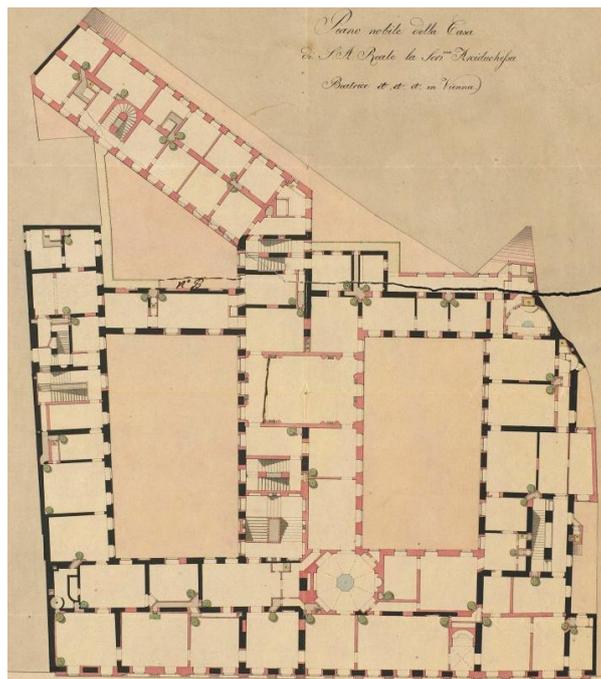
Luigi Pichl, Grundriss 1. OG Stadtpalais Modena, 1816, HHStA, Wien.
